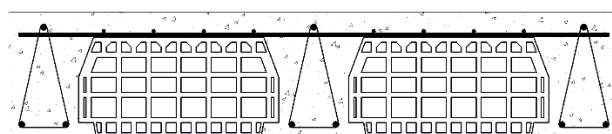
Фрагмент сборно-монолитного перекрытия с треугольным армированием (треугольные хомуты)
